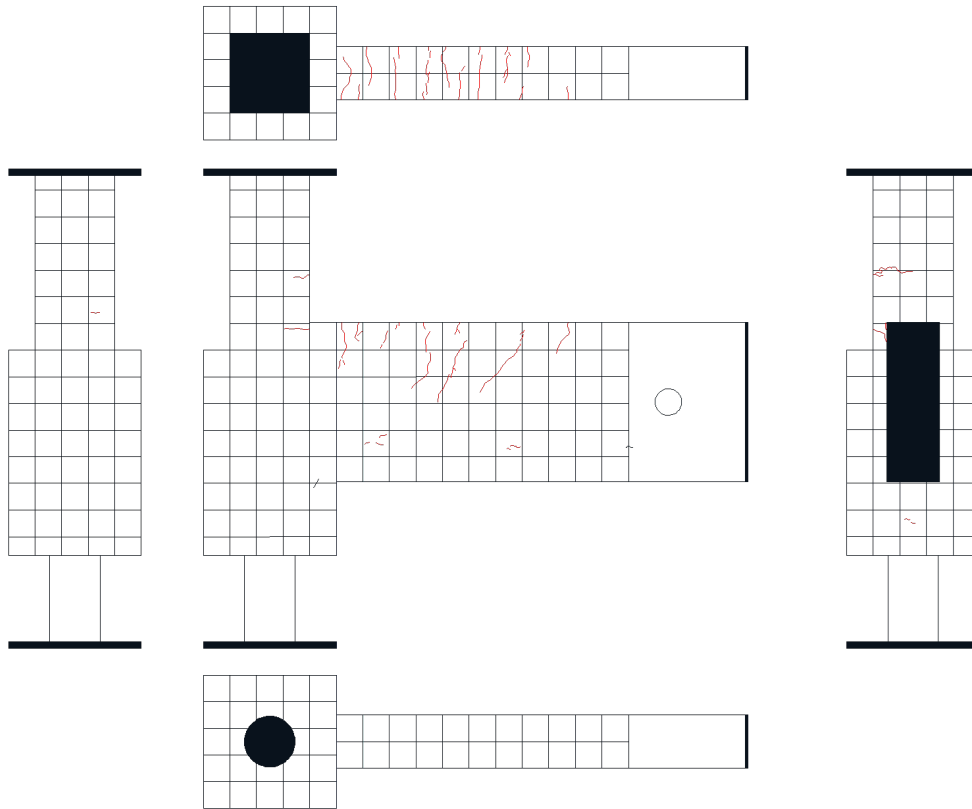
3. 175 試験体 D-2 ひび割れ状況 (2Cycle)
